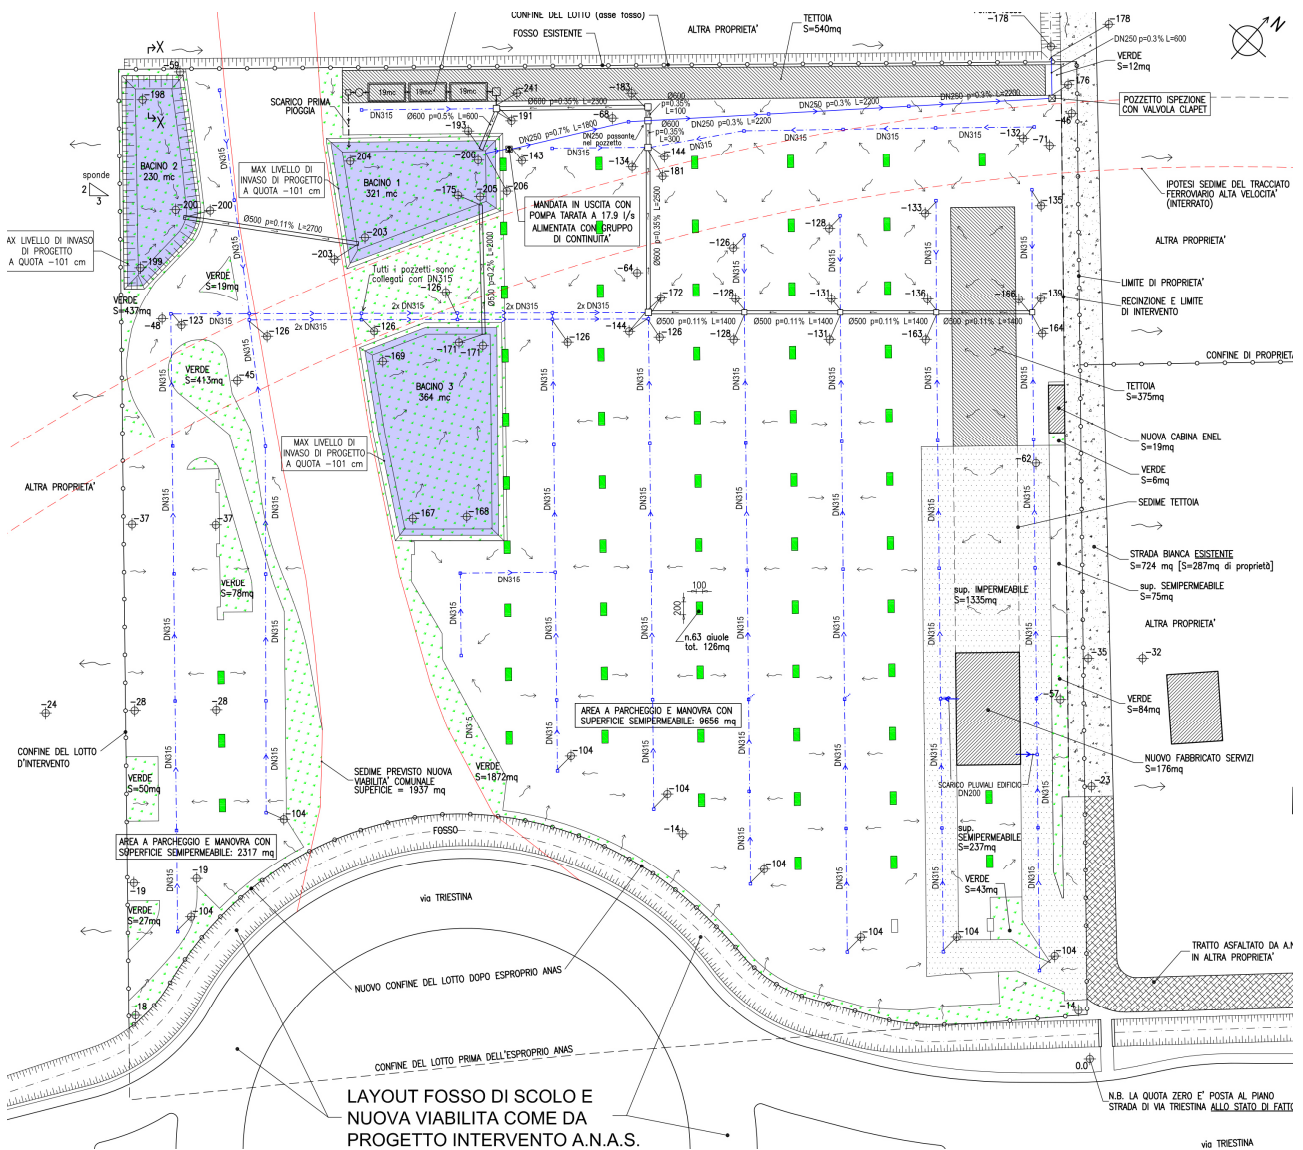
Pianta schema impianto laminazione acque meteoriche - lay-out di progetto successivo alla realizzazione della nuova viabilità comunale.
